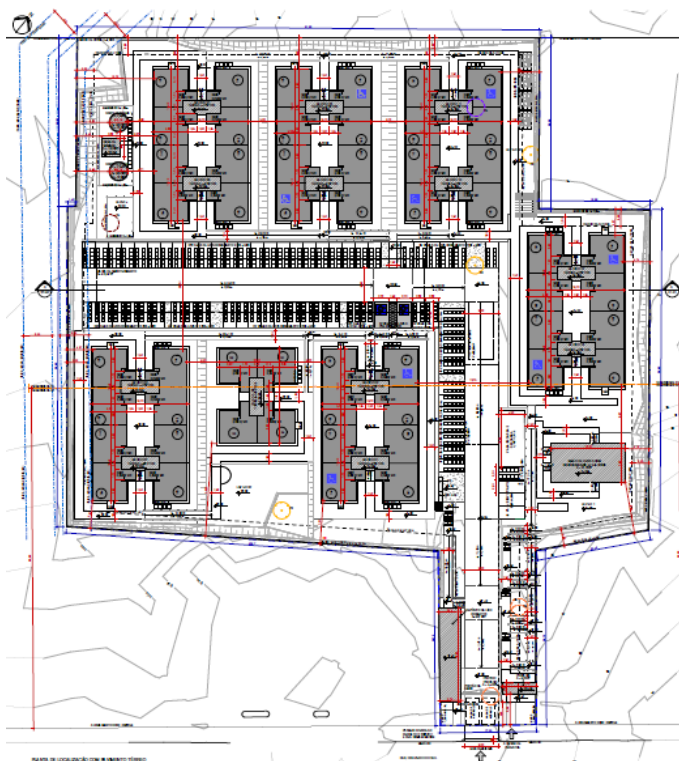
proposta de edificação. (fonte: Planta de EVU Edificação, doc. SEI Nº 18845201)
